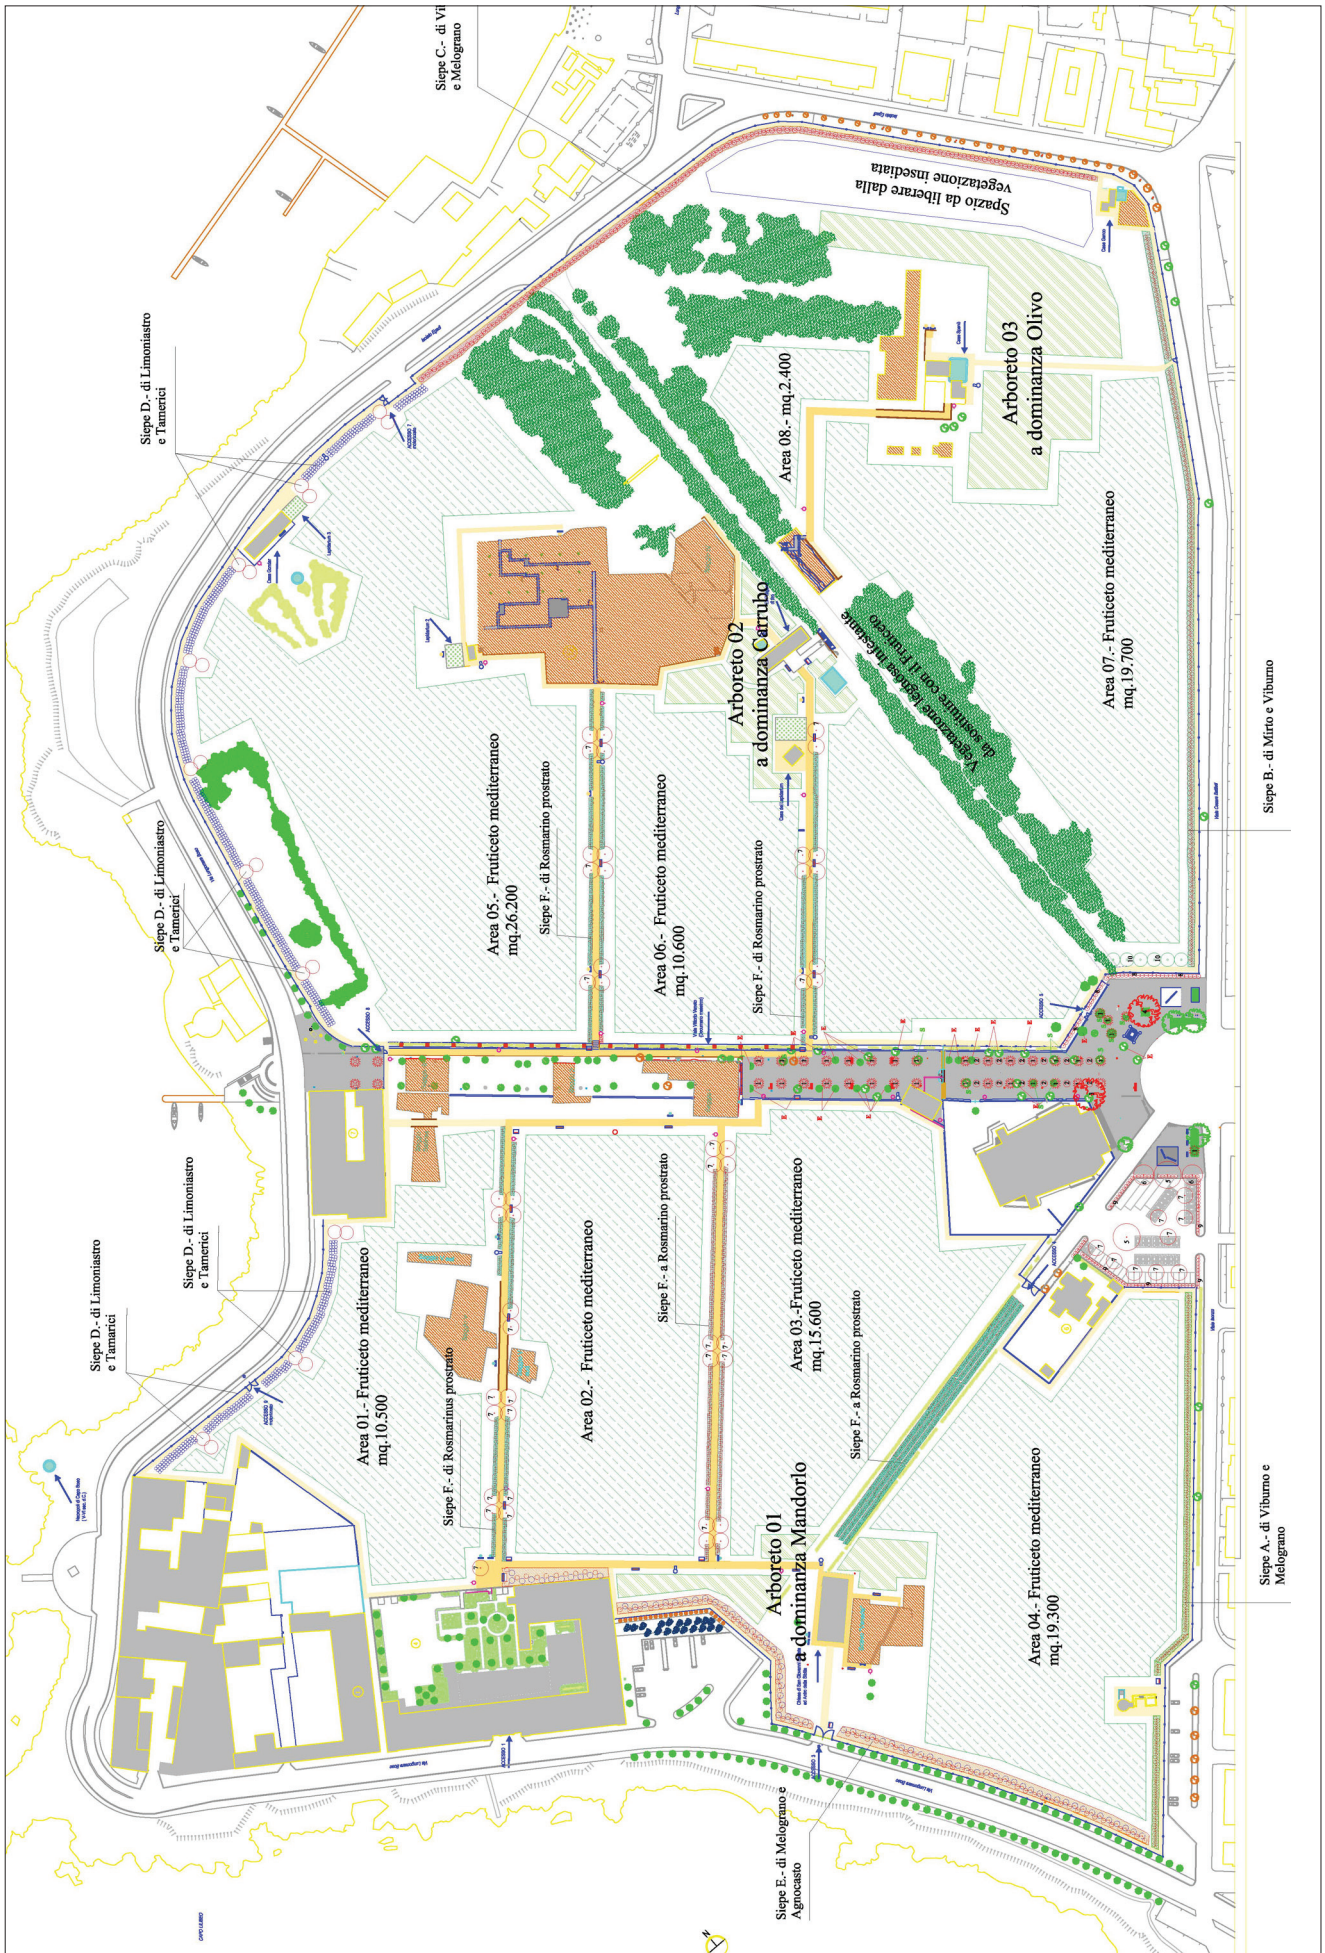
Elaborato planimetrico riportante la localizzazione degli interventi proposti.
